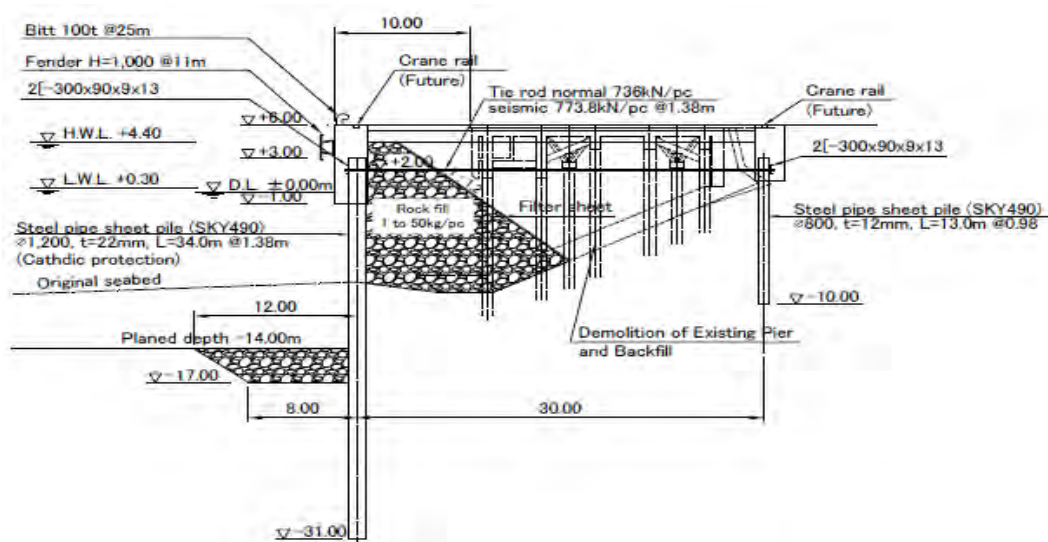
Tubos de folha de aço empilhadas no lado Sul (10 m de alargamento)
